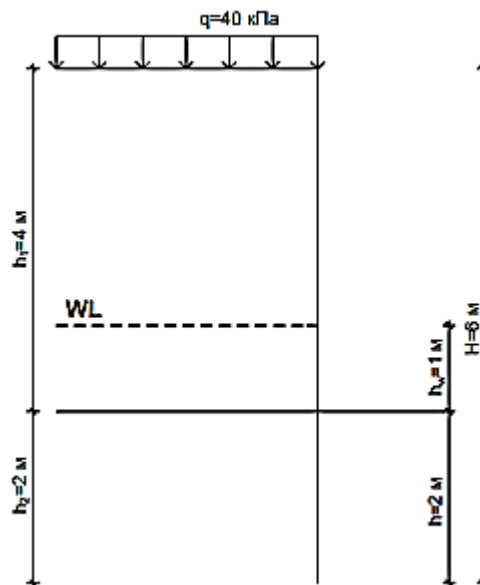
Схема шпунтового огородження до розрахунку
